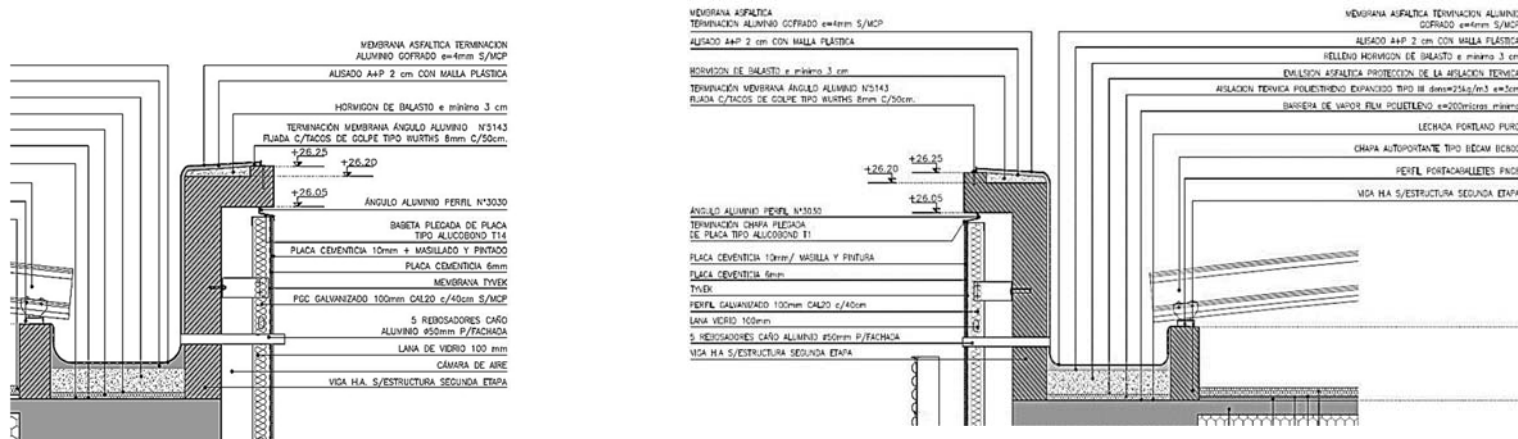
Centro Parque Batlle Detalle constructivo viga canalón.
